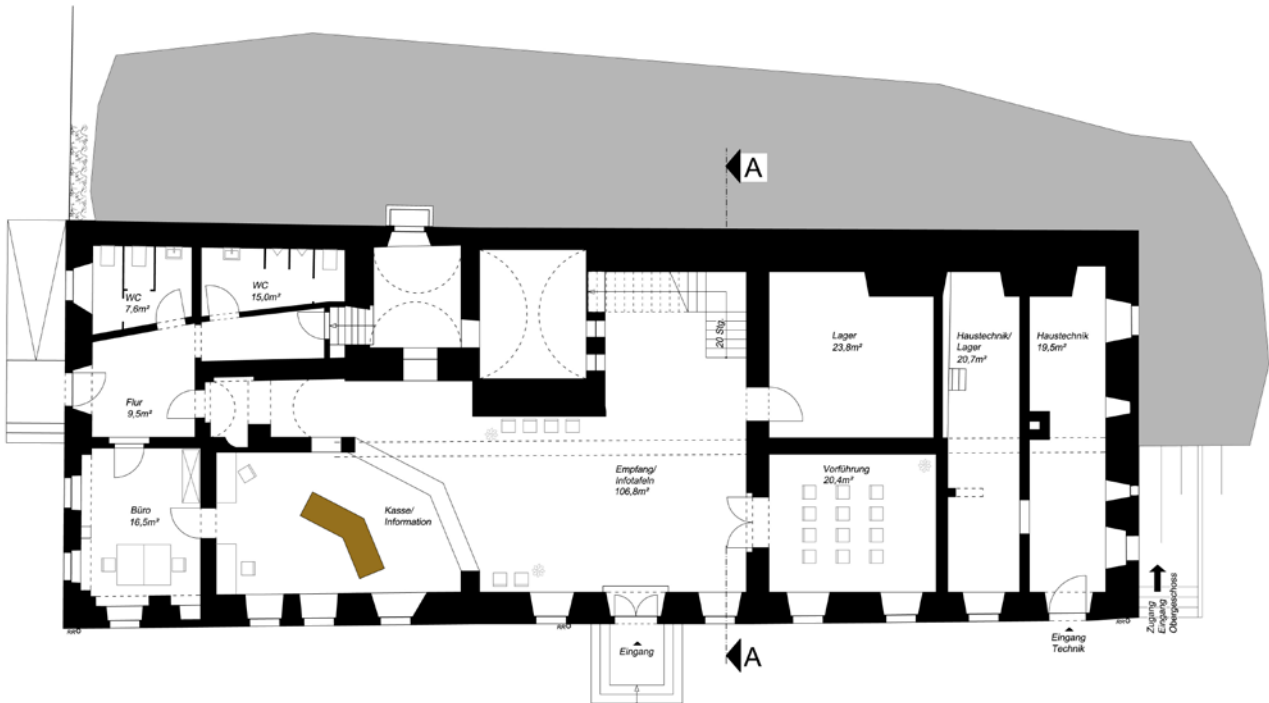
Grundriss Konzept Erdgeschoss
